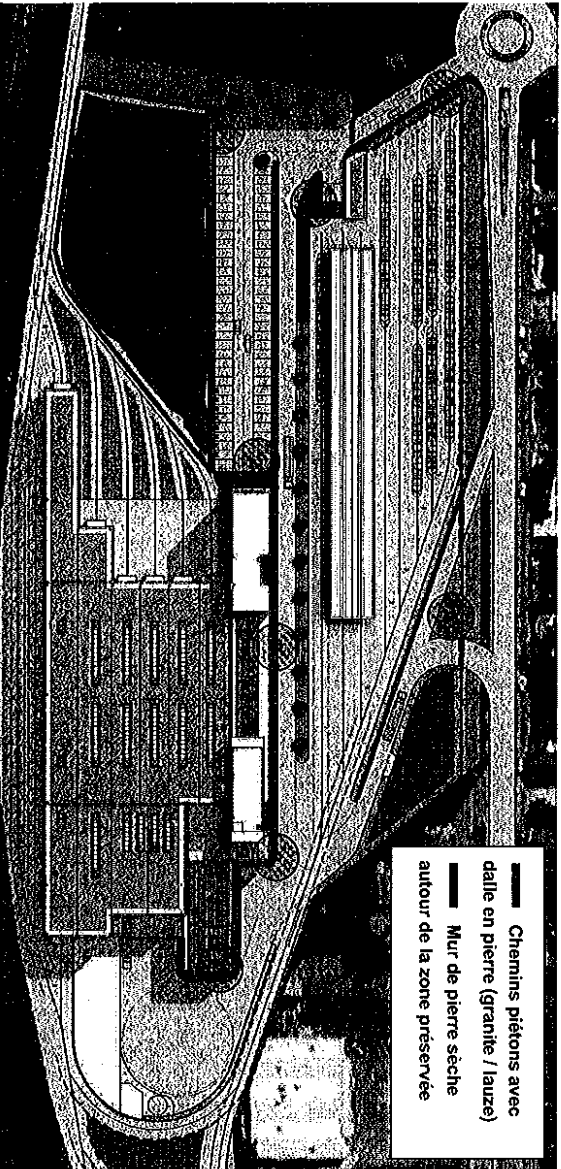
Localisation des chemins piétons avec des dalles de pierre et du mur de pierres sèches autour de la zone préservée (Source : ARFEP, 2013)
